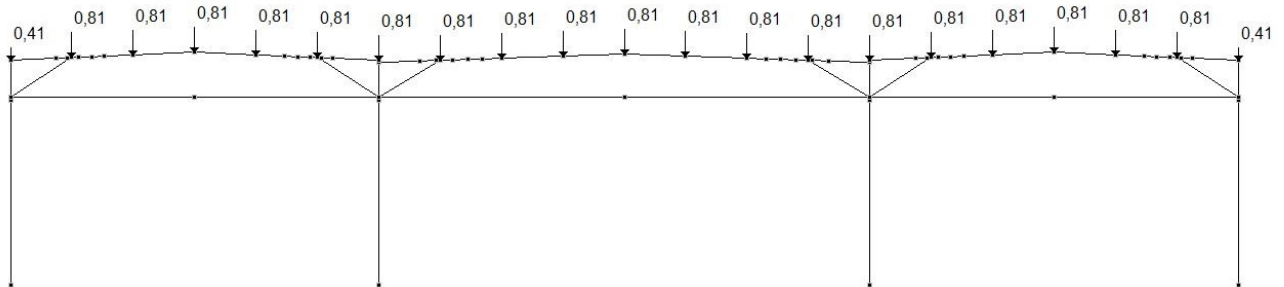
Схема постоянных нагрузок на стадии испытания конструкций (на схеме не показана нагрузка от собственного веса стропильных конструкций и колонн)
